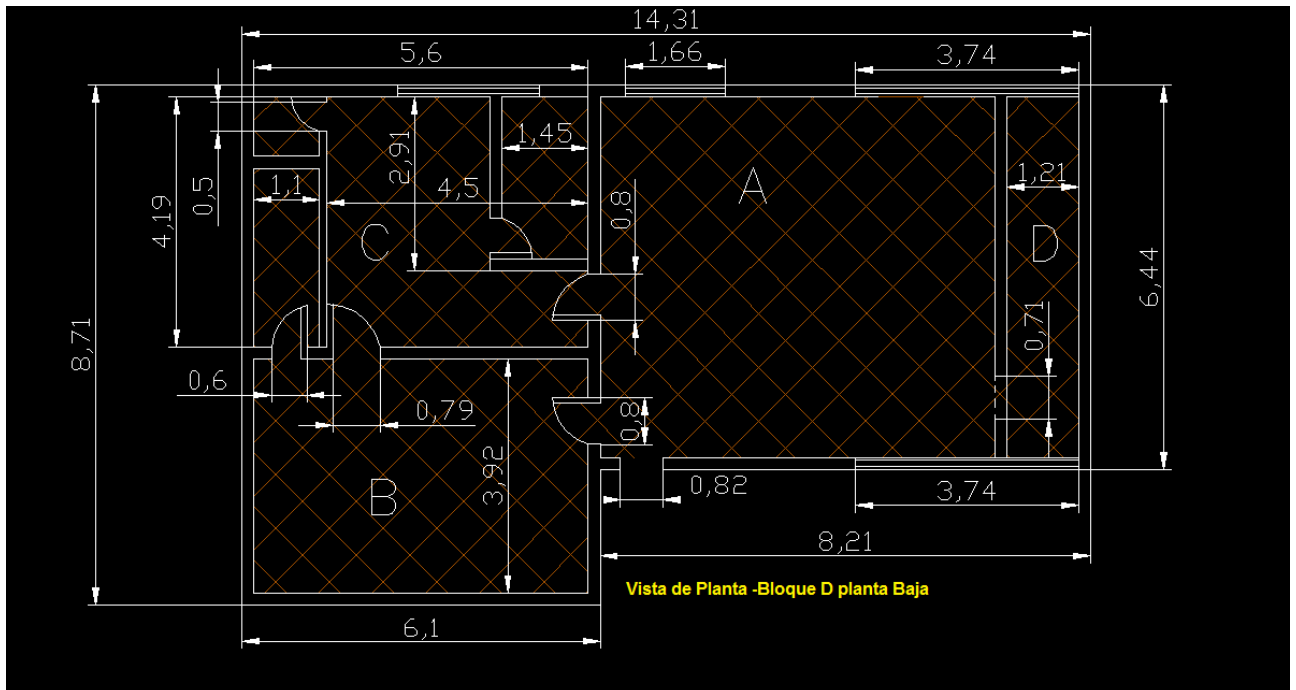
Vista de Planta de las áreas a ser consideradas.
